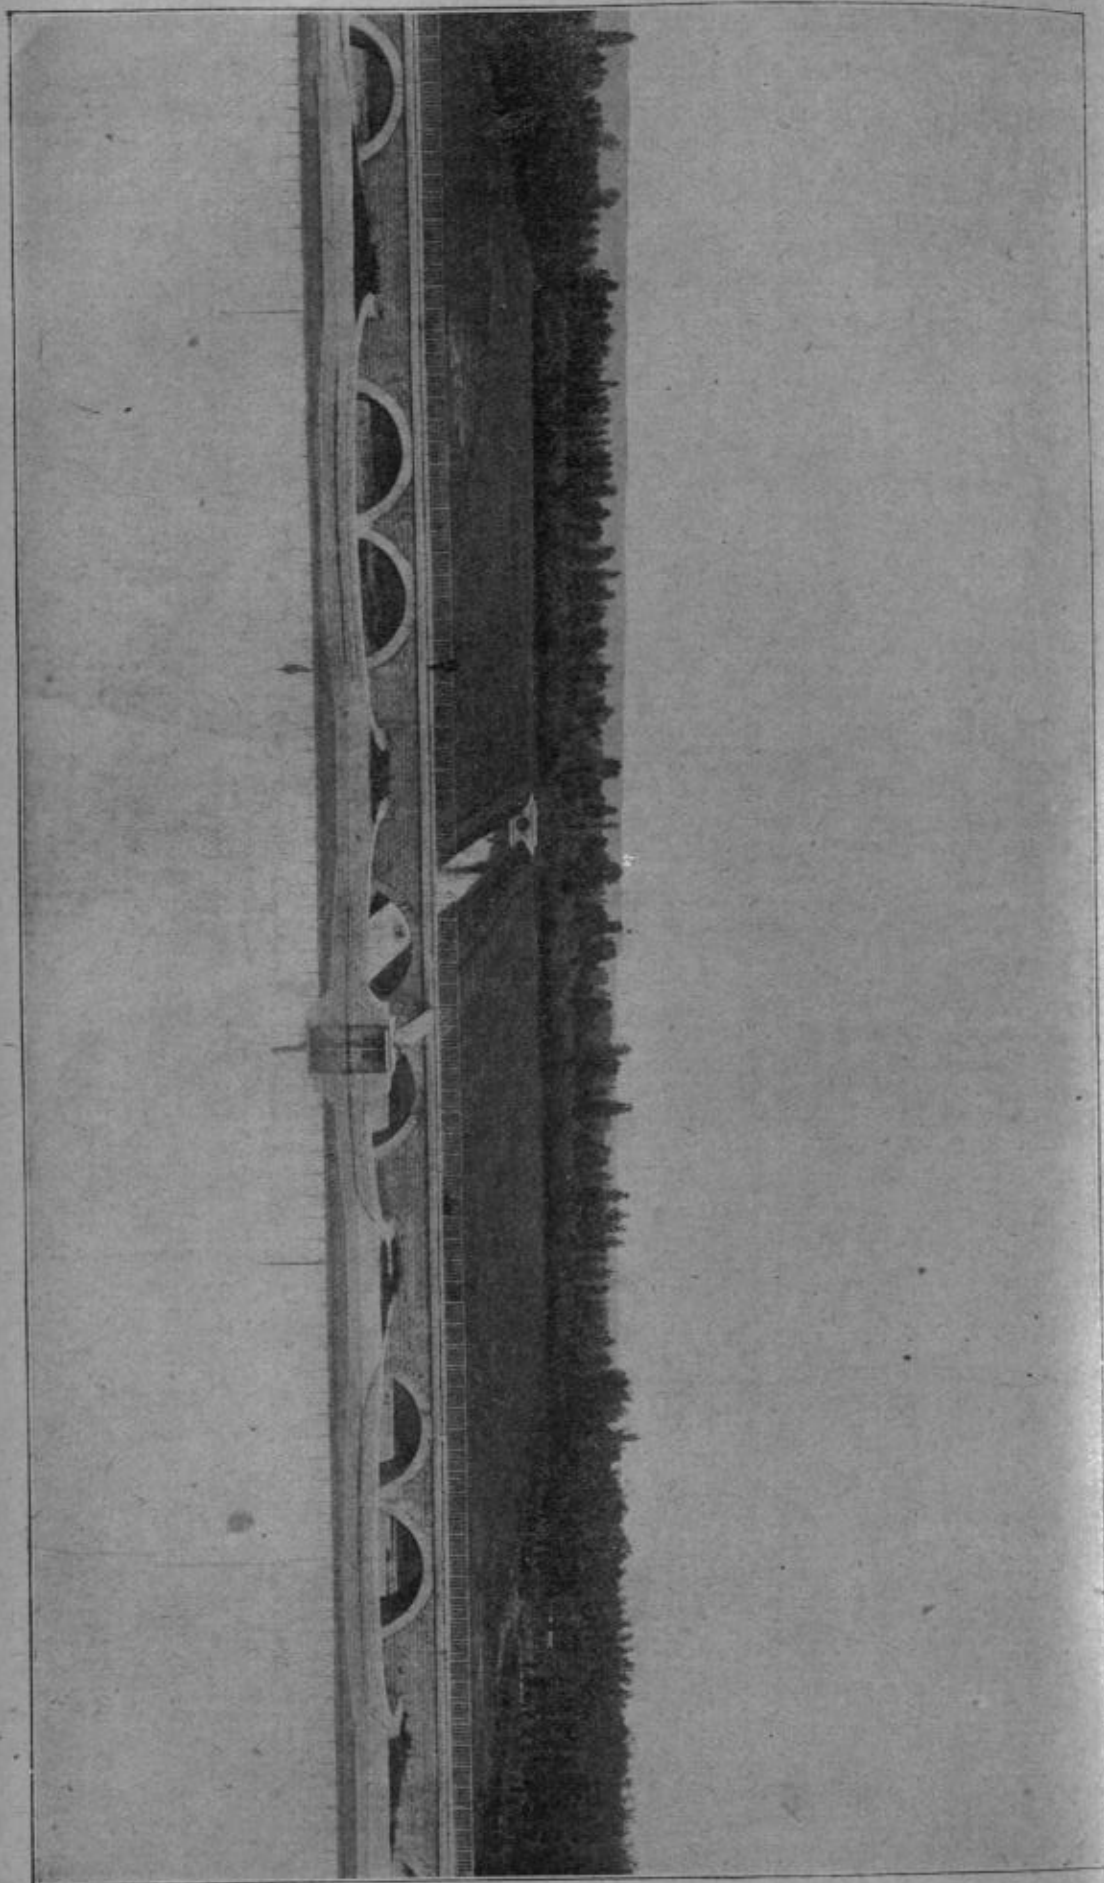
Usine de Jorag. Vue amont du déversoir.
